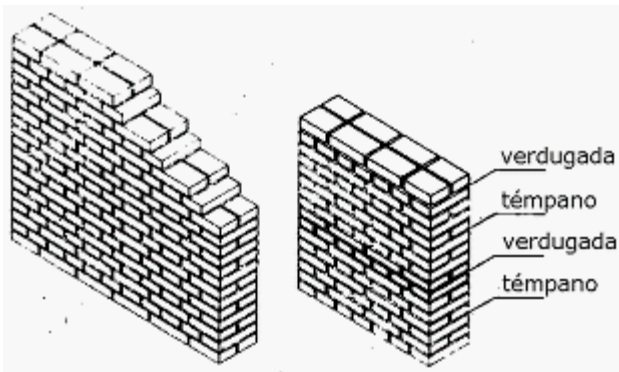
Detalle muro aparejado de una hoja. 2014. Cype
